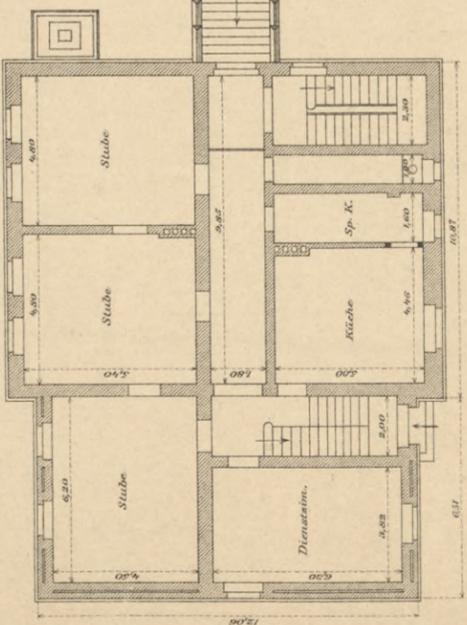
Zollbeamtenwohnhaus. Erdgeschoss. 1: 225.
